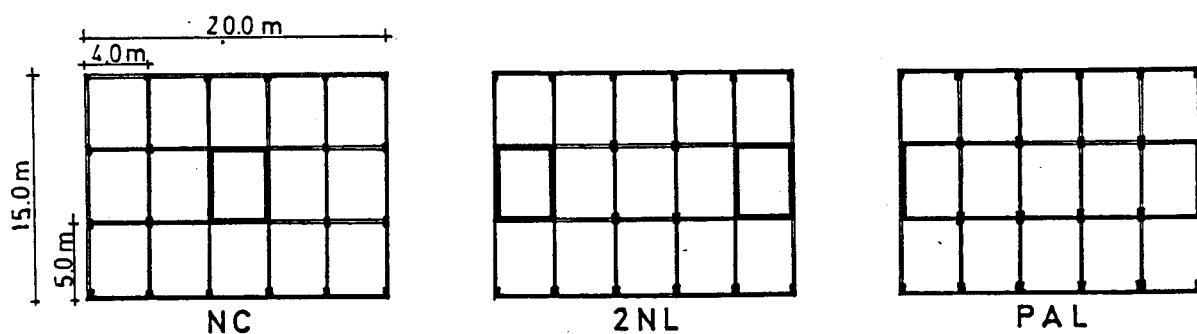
Disposição em Planta dos Edifícios em Estudo
